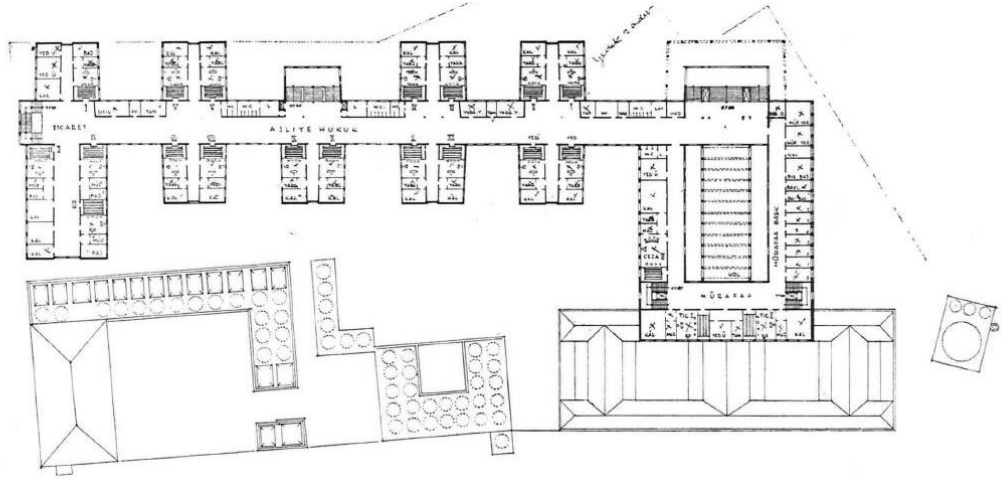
Adalet Sarayı Zemin Kat Planı (Aziz, et al., 1949)
